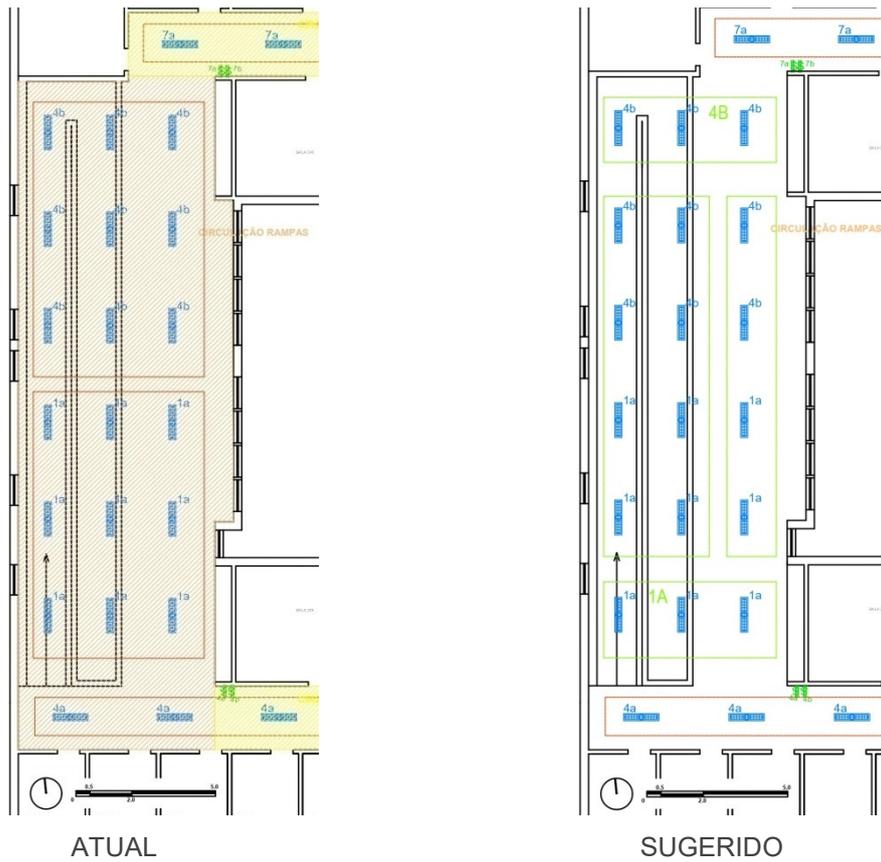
Planta de distribuição dos sistemas de acionamento e iluminação da circulação próxima às rampas no 2º pavimento. Fonte: Redesenho dos autores.
